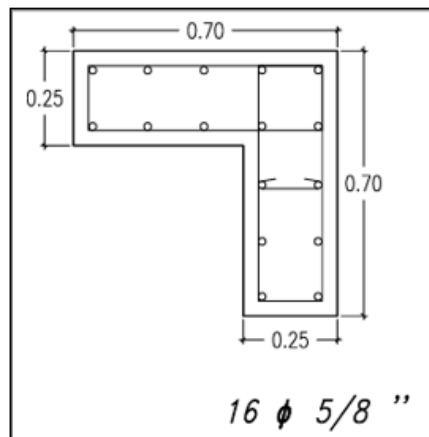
Armado preliminar de la sección transversal de la columna CL-04.
